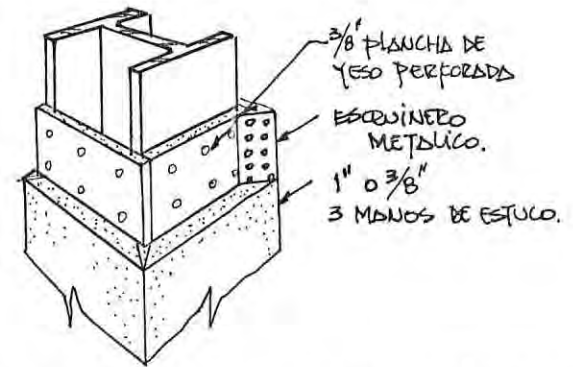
Columnas con protección de estucos de yeso, sobre panel de yeso.
